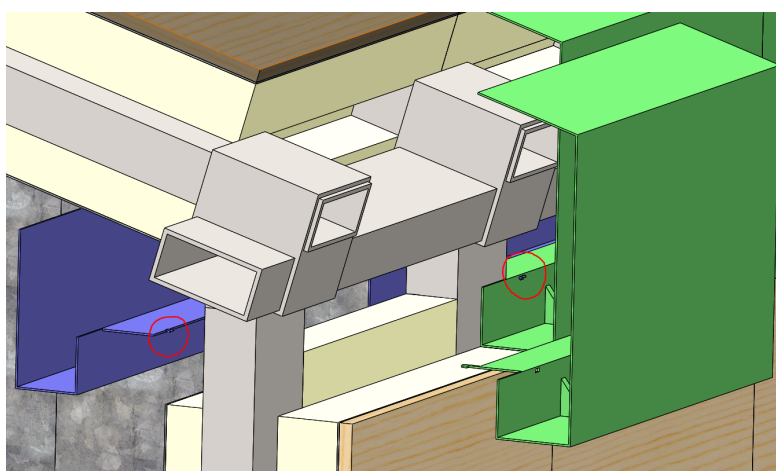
Montagem das tampas da ligação parede-teto das parede longitudinal inferior - ângulo inverso.
